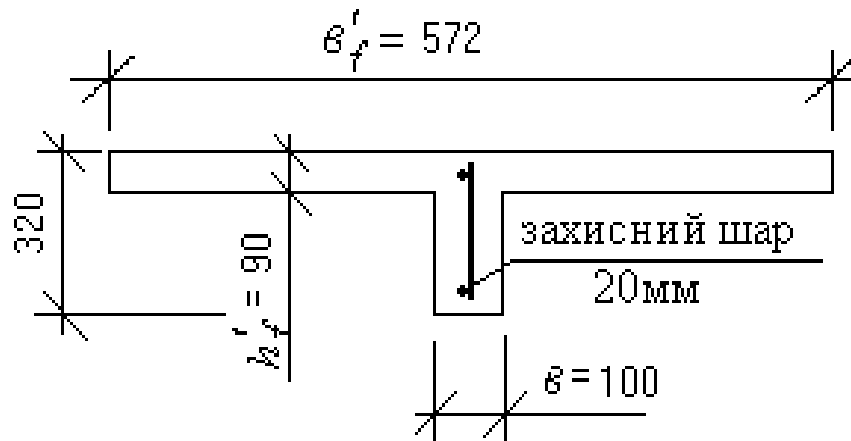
Розрахункова схема перерізу ребра балки
